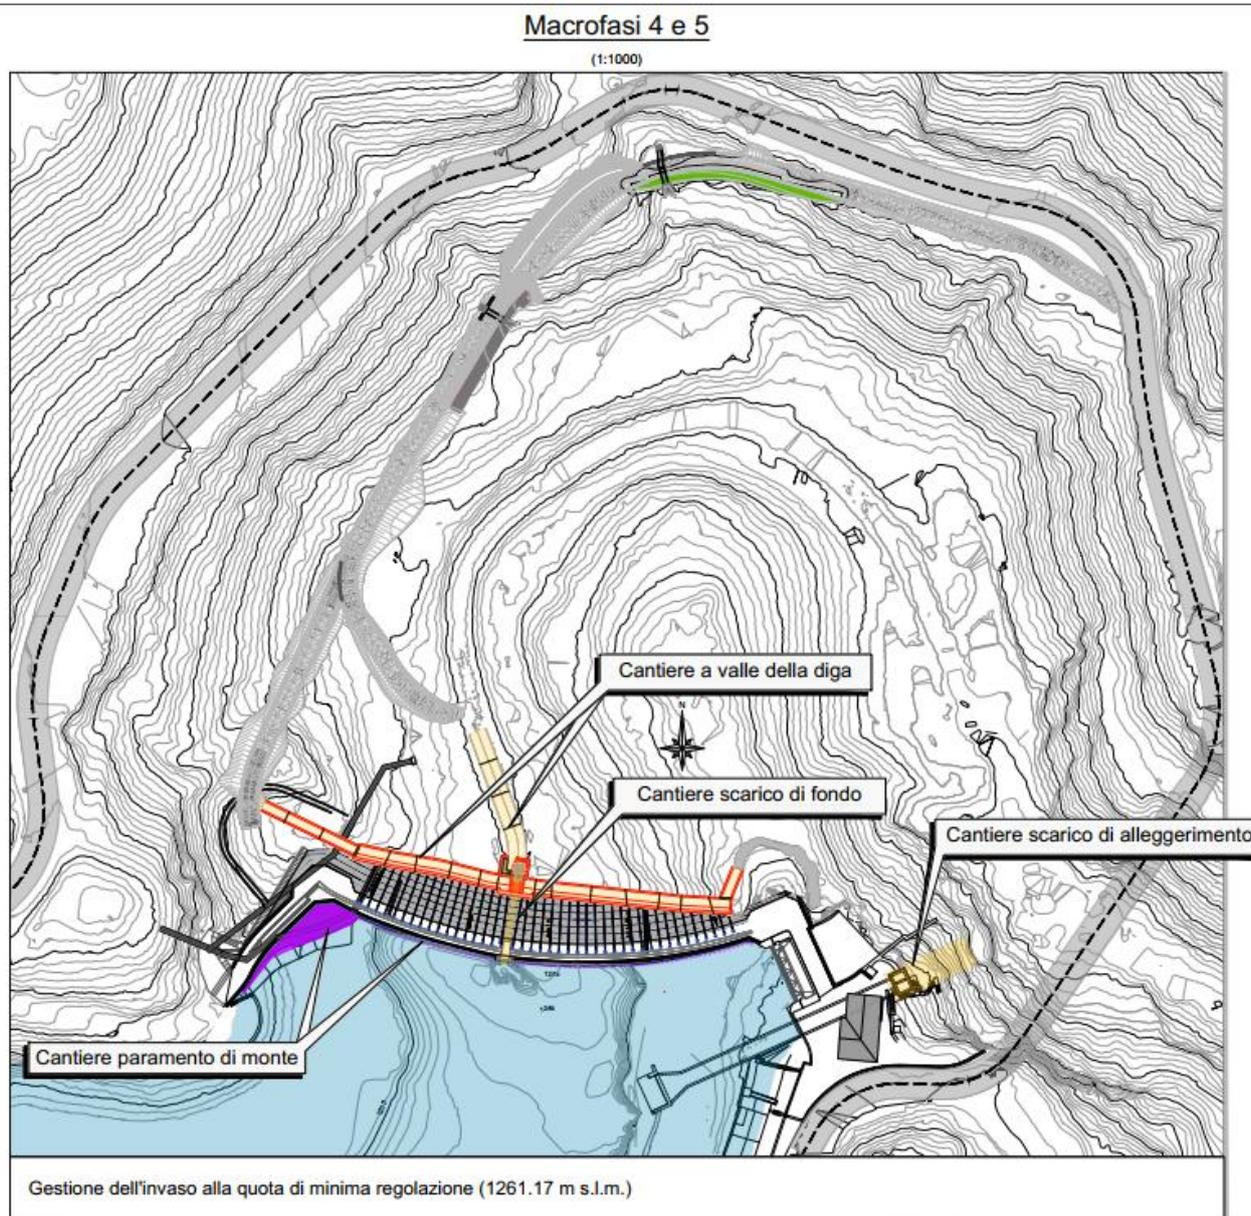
planimetria con indicazione delle principali lavorazioni previste nella macrofasi 4 e 5
